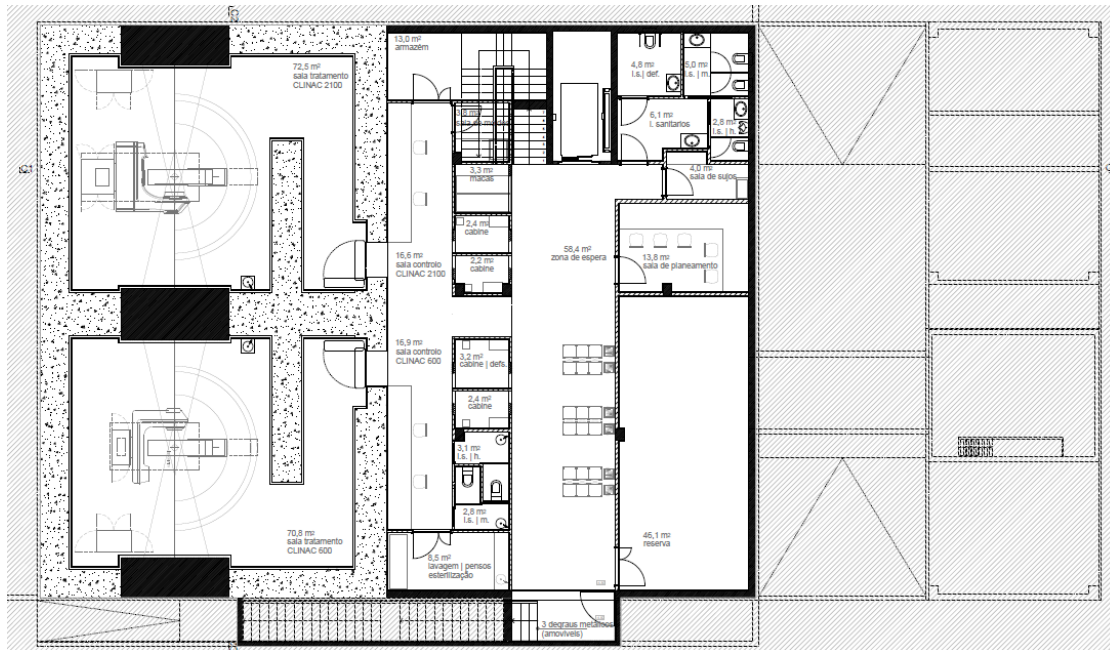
Planta do piso -1 – planta de arquitetura em AutoCad
